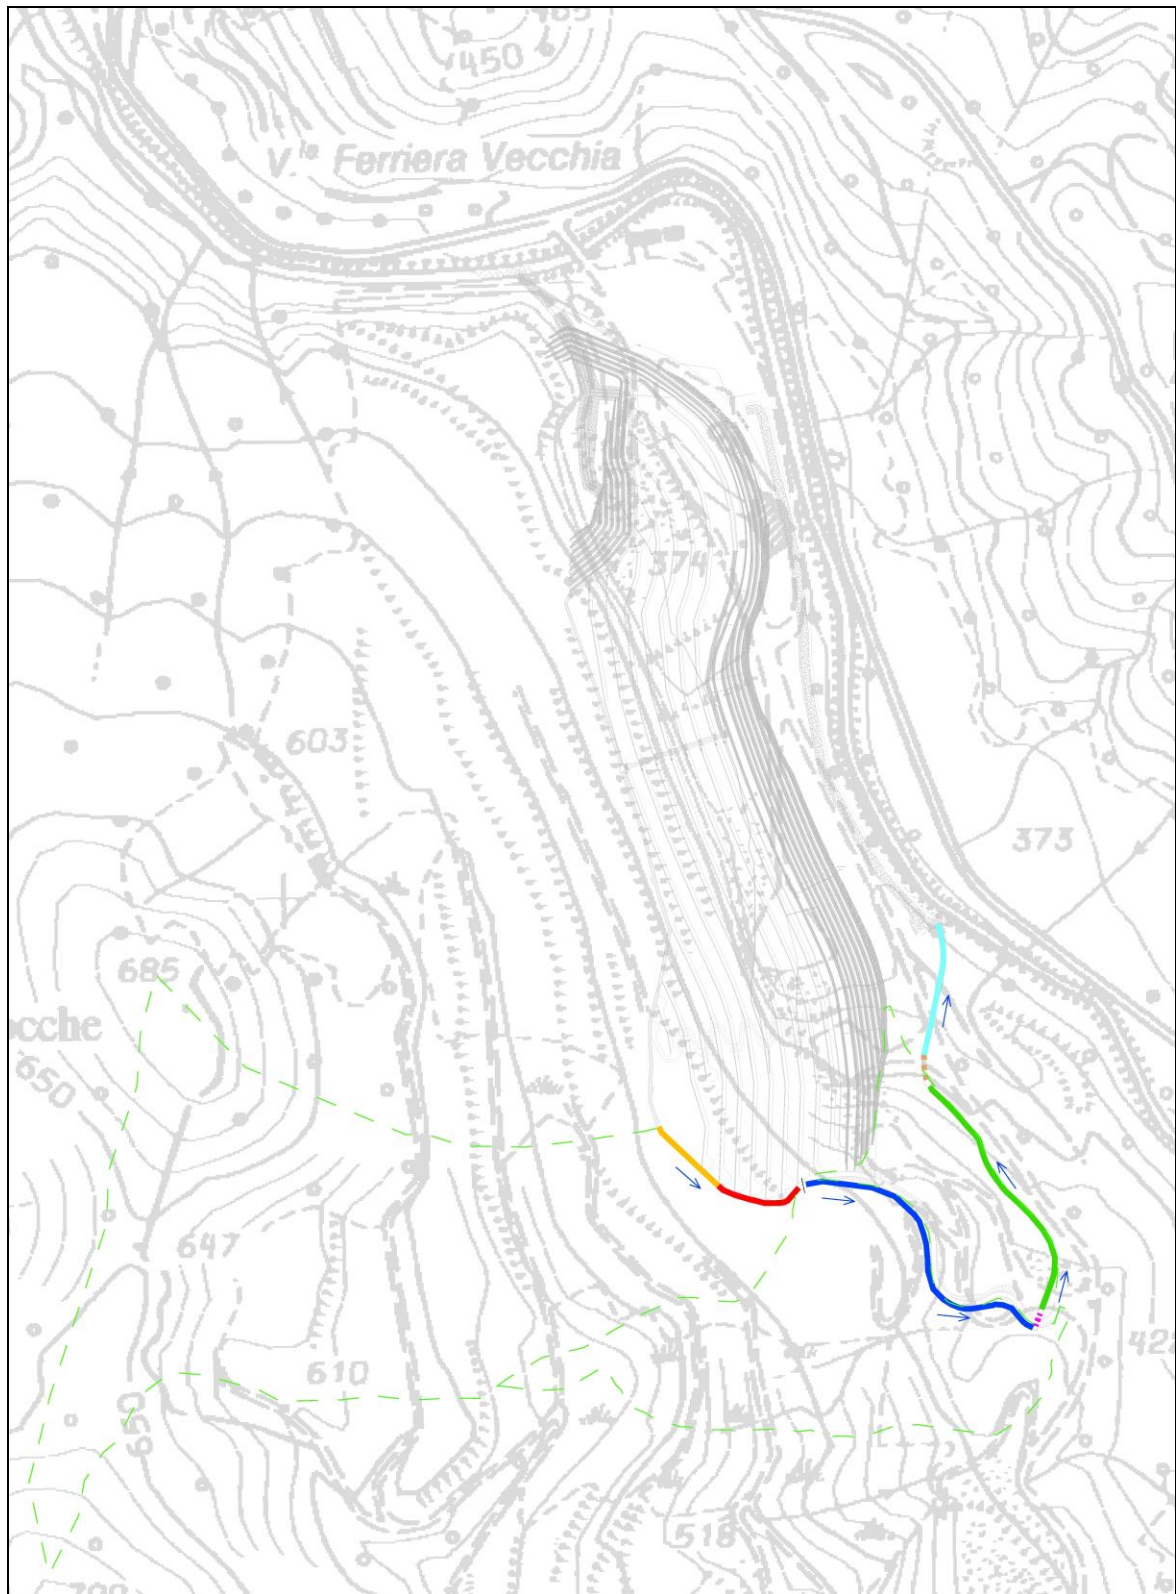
Sistema pluviometrico sud – Schema drenaggio
